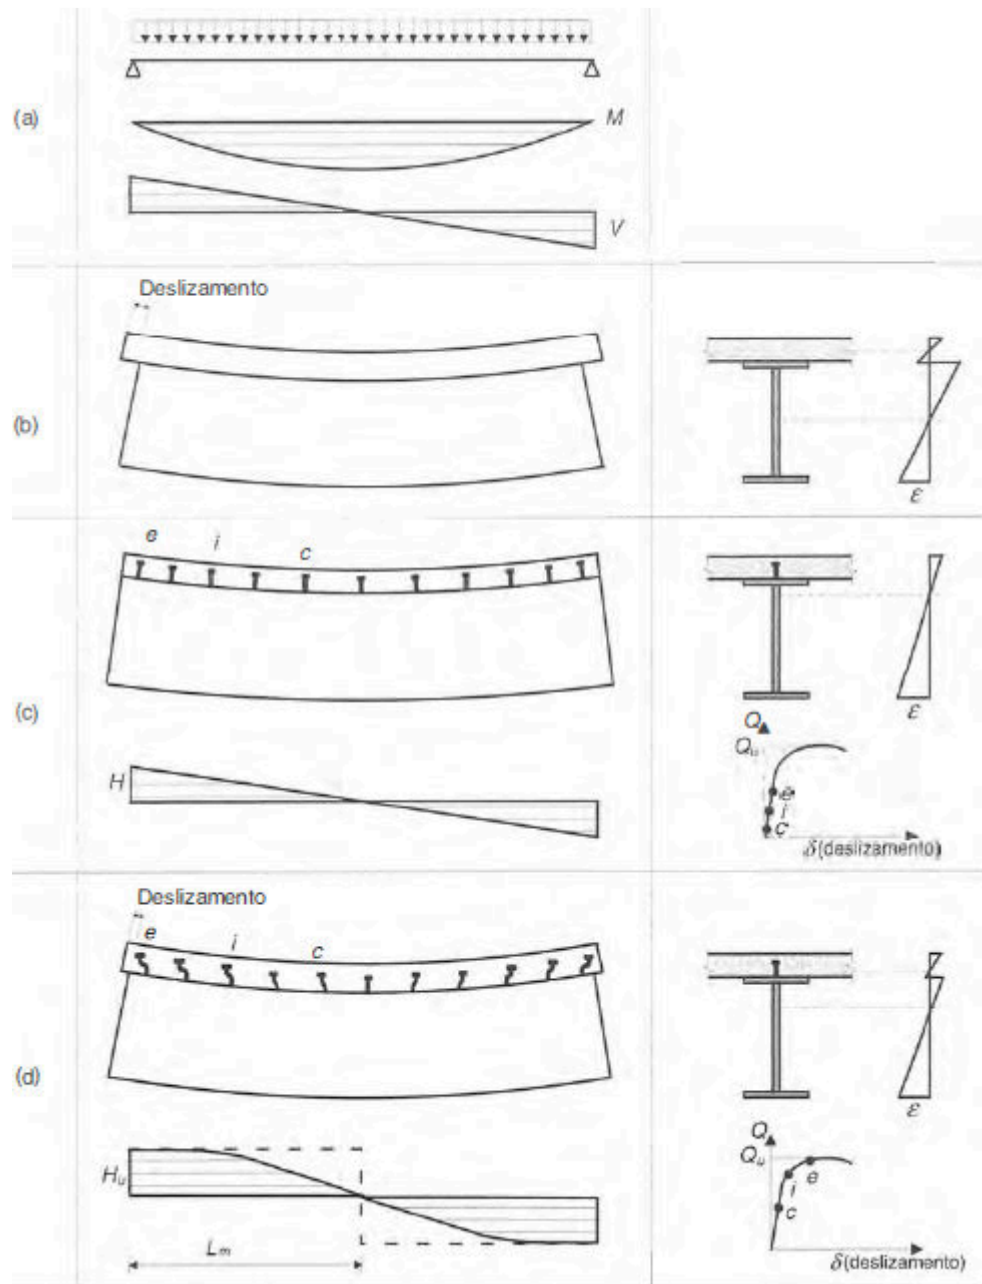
Funcionamento de uma Viga Mista: a) viga biapoiada sob carga uniformemente distribuída; b) viga de aço e laje de concreto sem conectores; c) viga mista interação completa d) viga mista interação parcial; (PFEIL, 2009)
